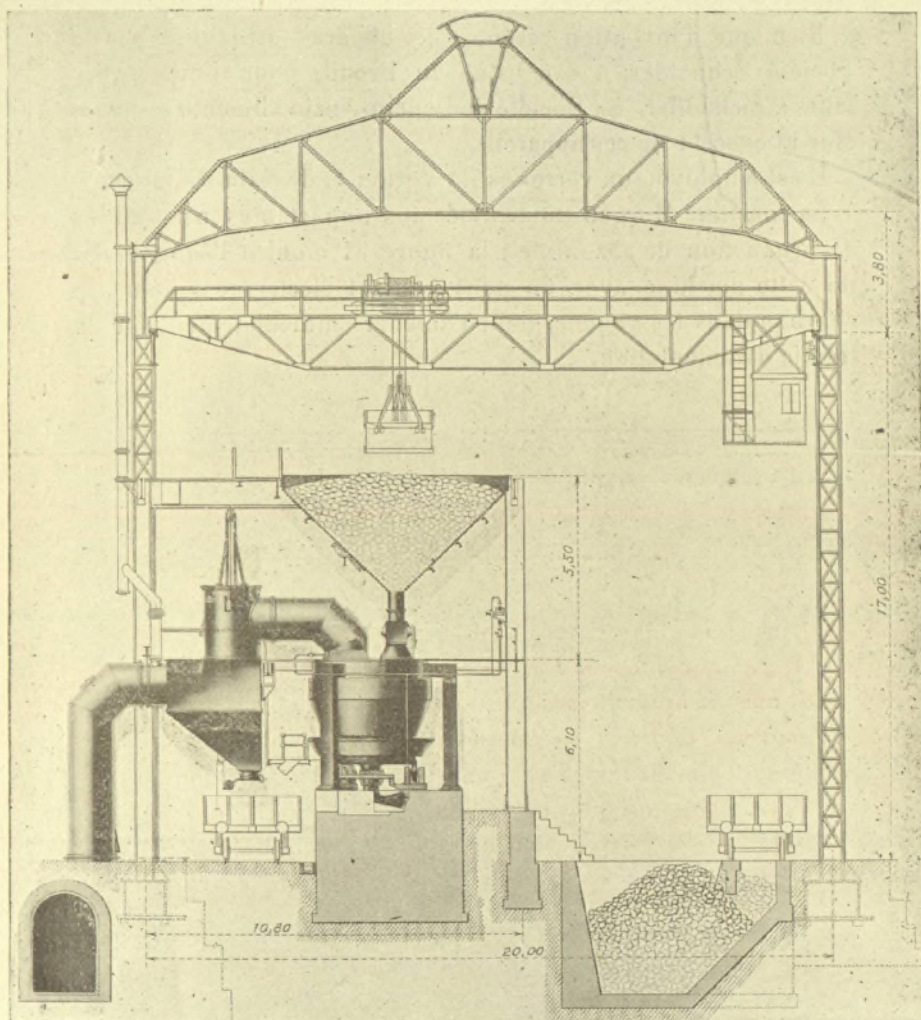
Coupe d'une installation de machine à gazéifier Morgan.
